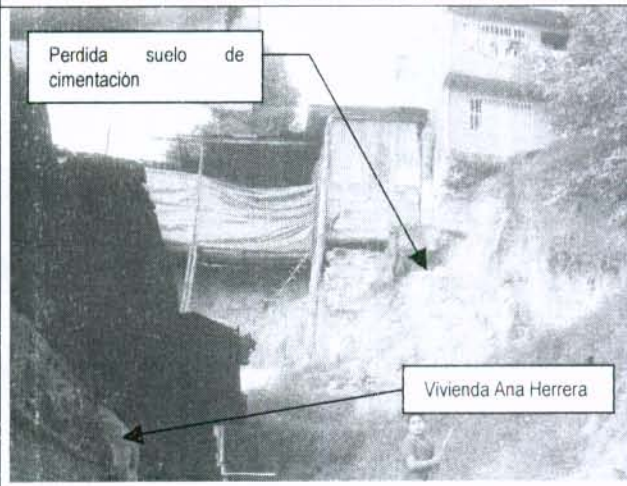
Se aprecia el riesgo existente sobre la vivienda de la señora Ana Herrera por el colapso de las viviendas ubicadas en la parte alta del talud.
